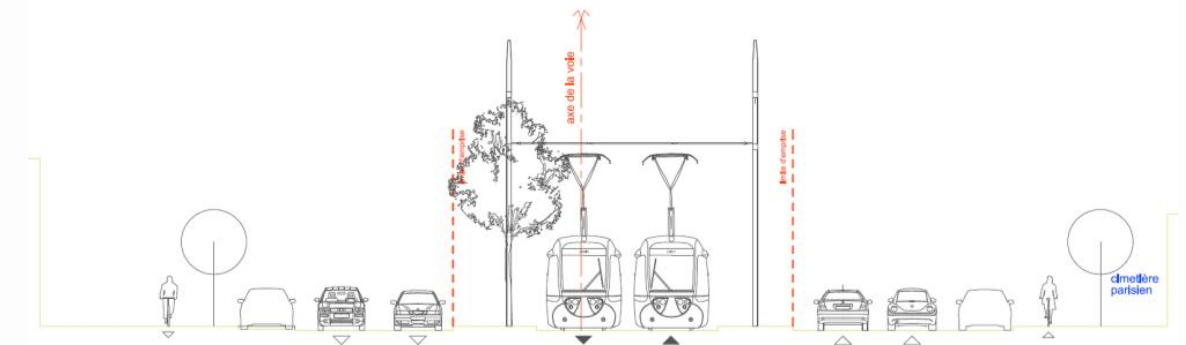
Exemple de coupe d'insertion avec pistes cyclables bilatérales sur trottoirs
